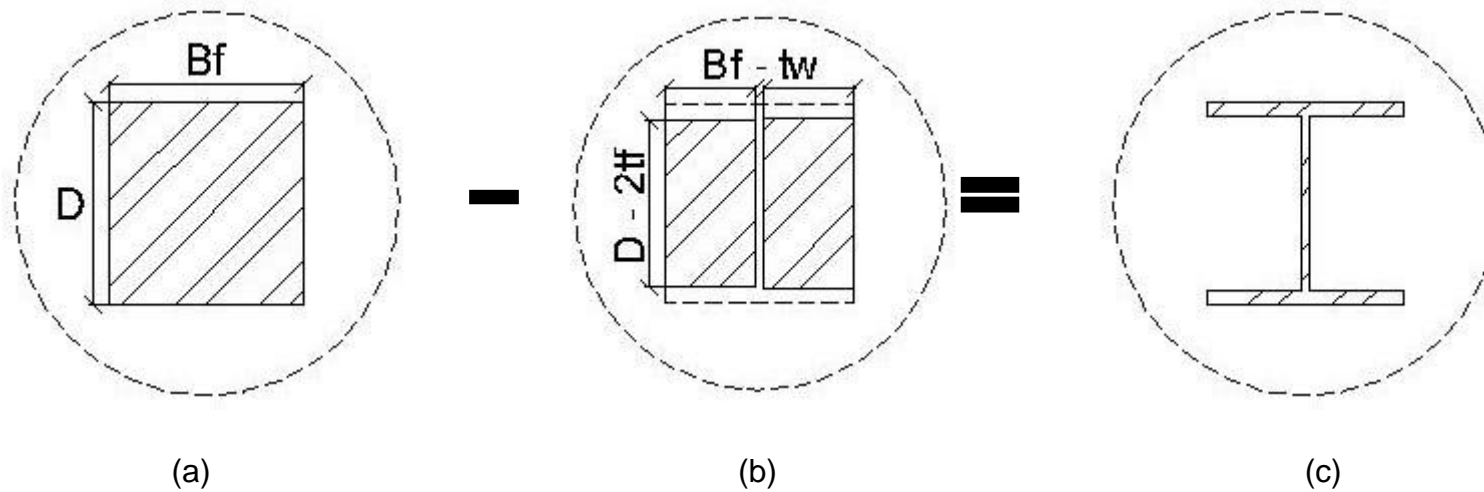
Suma y resta para espacio perfil W sección circular concreto
